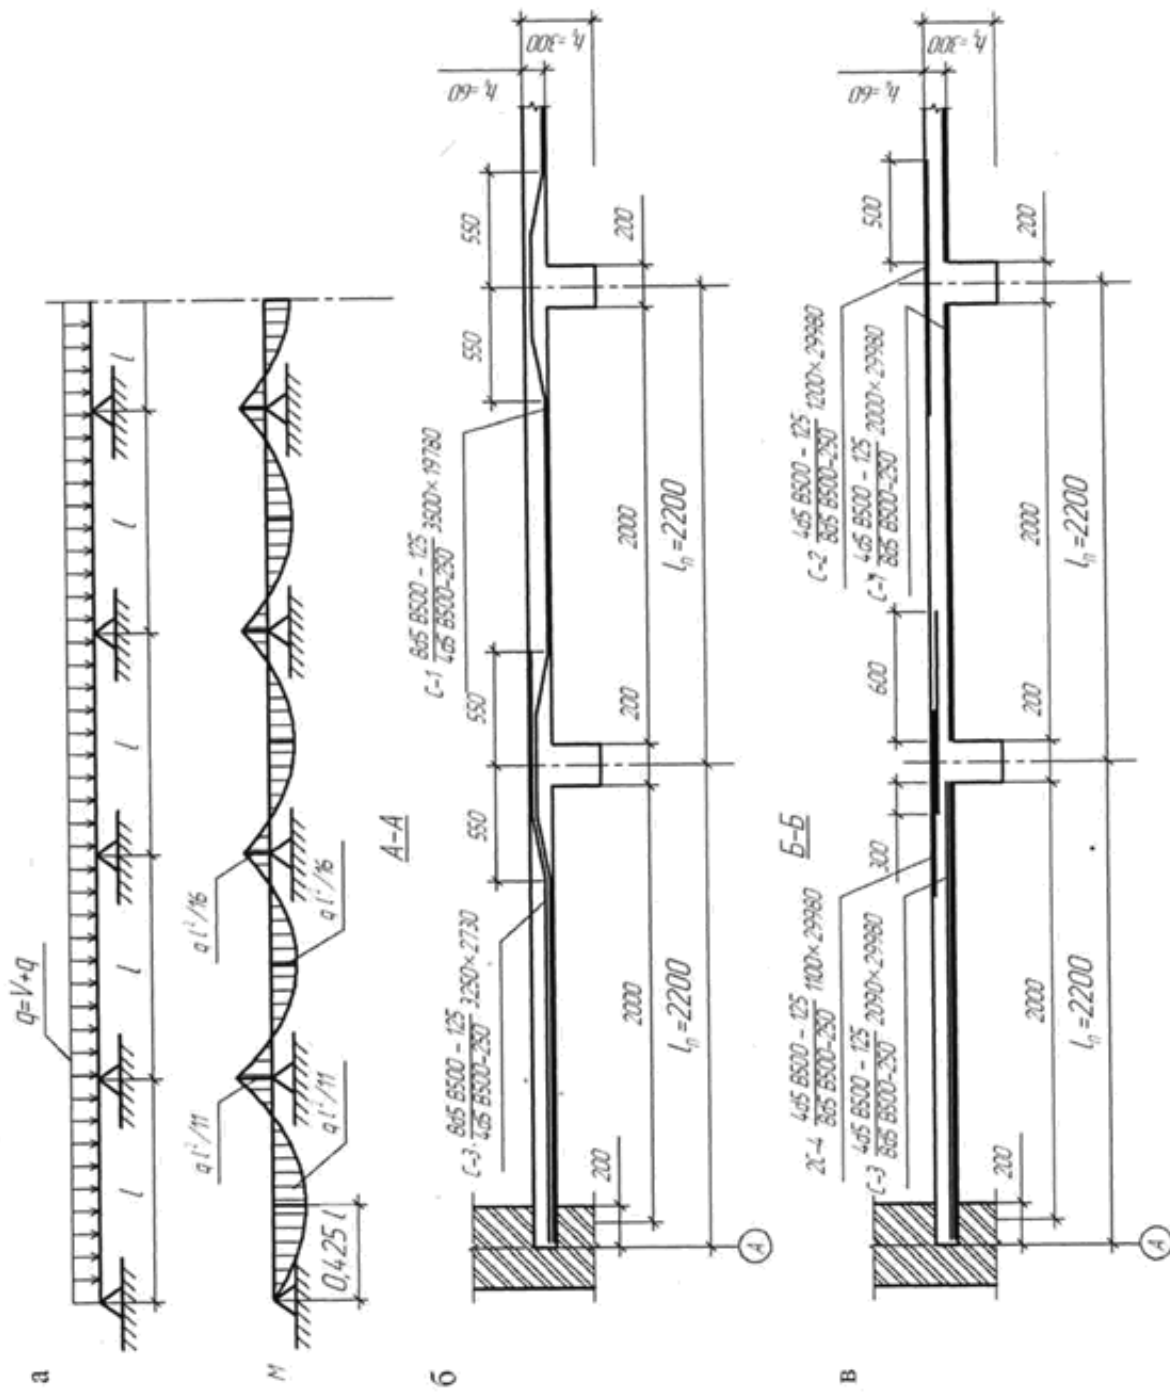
Армирование балочной плиты: а – расчетная схема и эпюра М; б – разрез А-А (вариант армирования 1); в – разрез Б-Б (вариант армирования 2)
